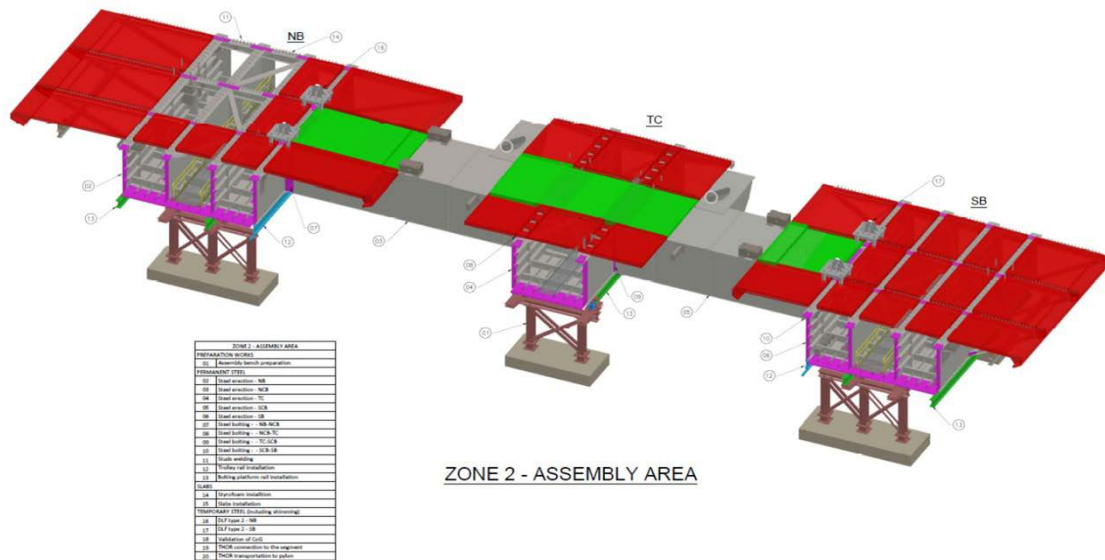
Configuración de la dovela tipo. Puente de Champlain.
